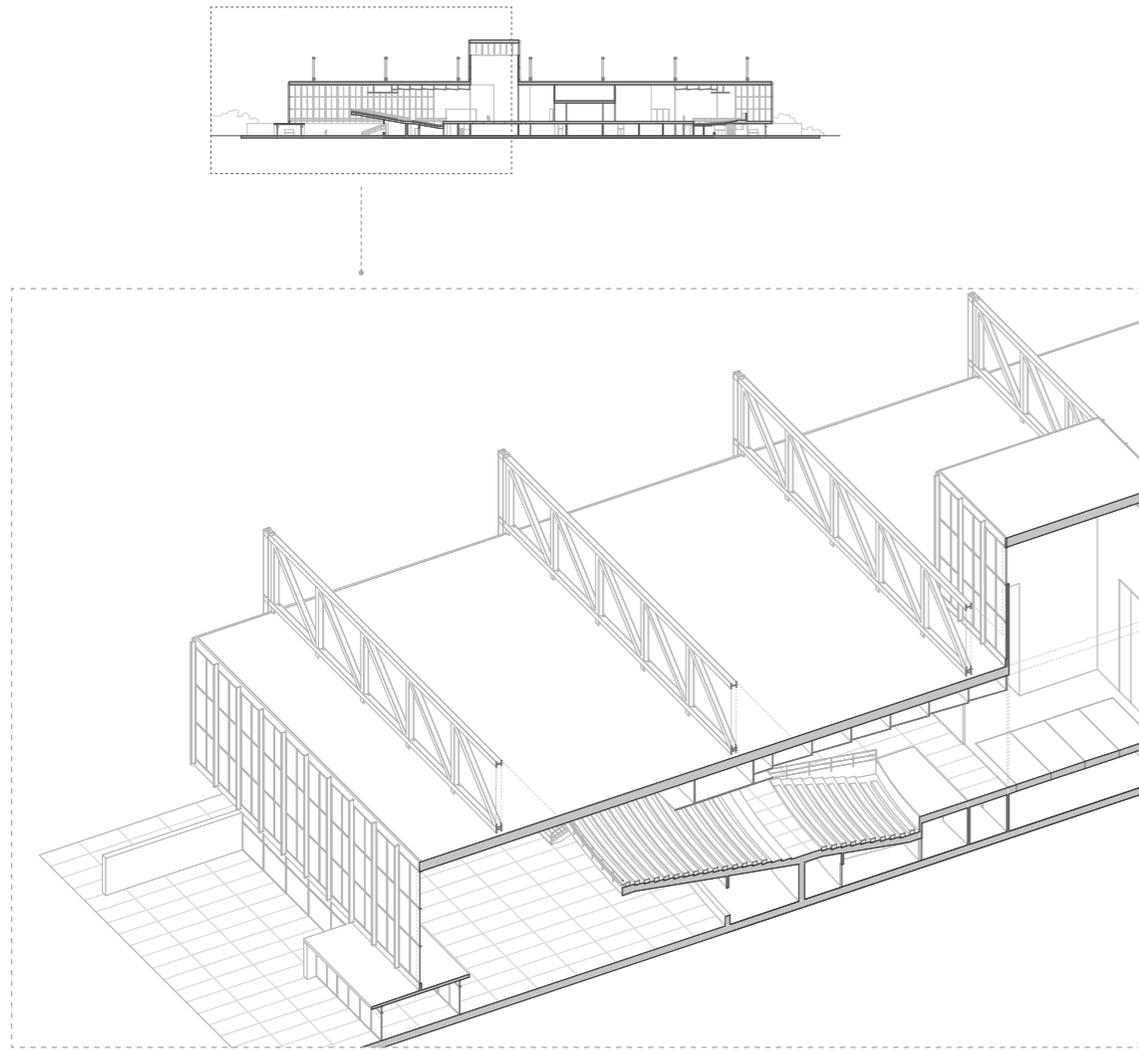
Axonometría seccionada longitudinalmente. Detalle auditorio mayor.
